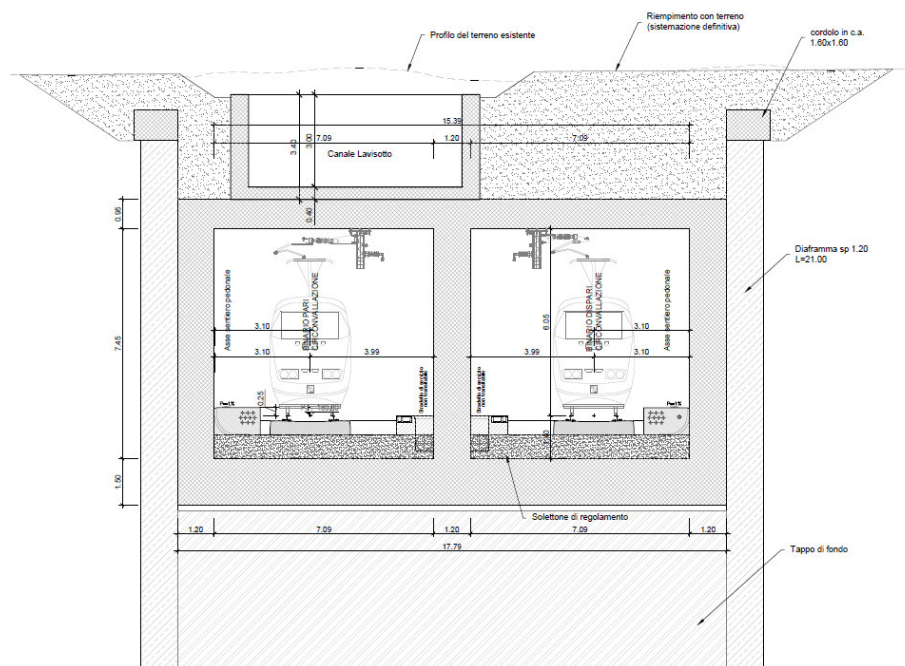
GA02. Sezione trasversale in corrispondenza del canale Lavisotto
